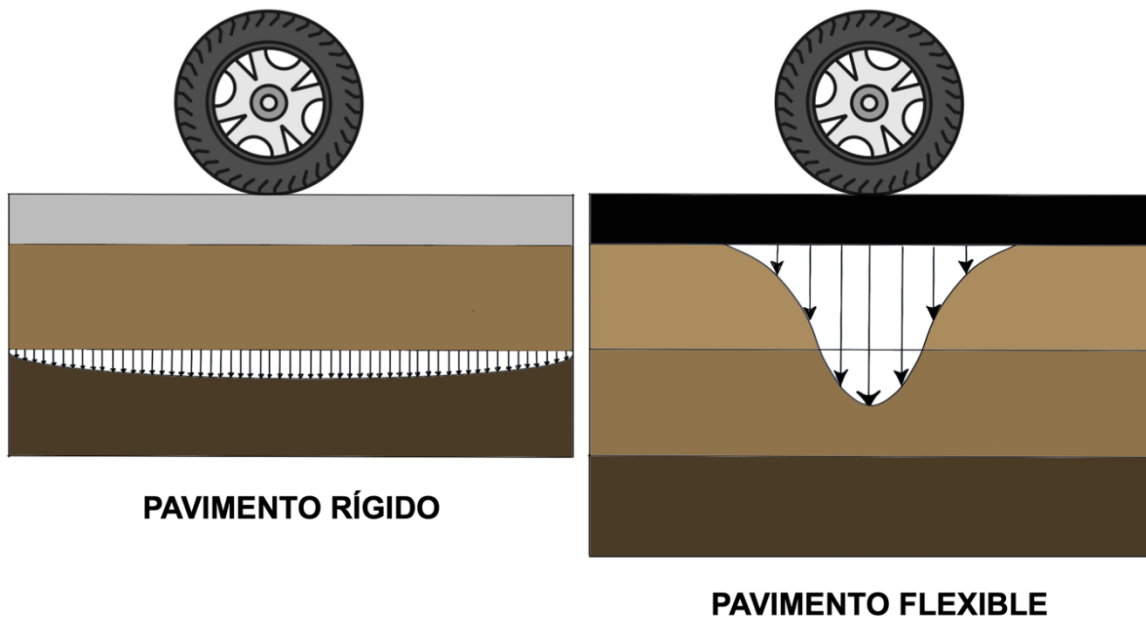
Distribución de cargas, en pavimento rígido y pavimento flexible. Fuente: Elaboración Propia.
